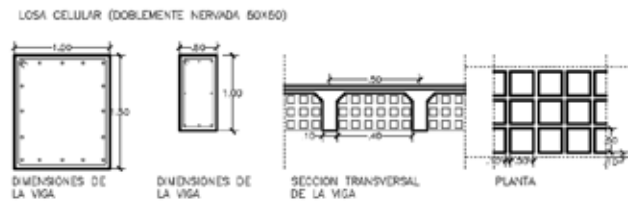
Detalle de losa Celular, fuente: La Autora (2017).
